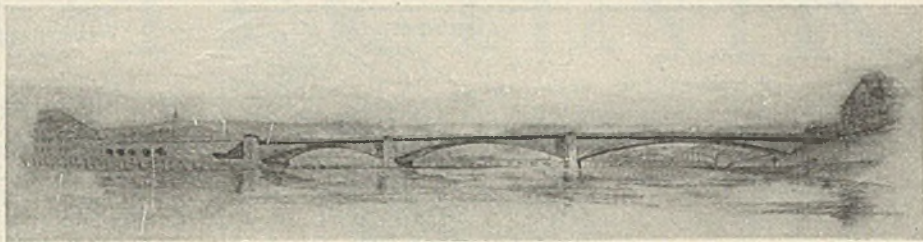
Entwurf der Fa. Grün & Bilfinger A.-G. (Mannheim) mit Architekt Abel (Köln). Zur Ausführung empfohlen.
